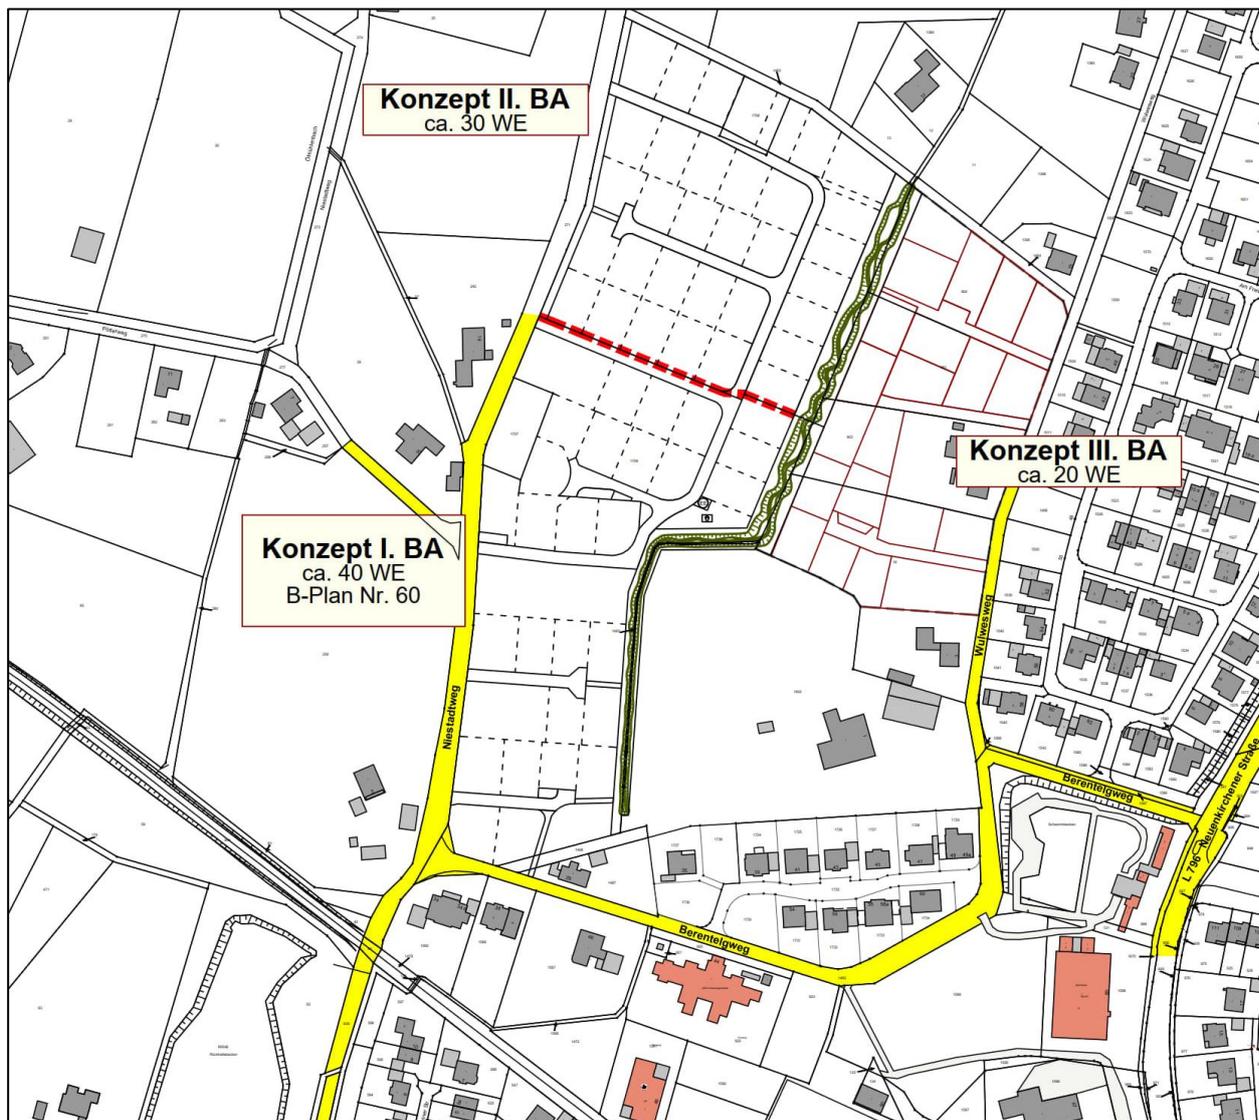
Ausschnitt aus dem Lageplan „Grundstücksplan Konzept“ [Quelle: Gemeinde Mettingen, Stand: 18.09.2023]
